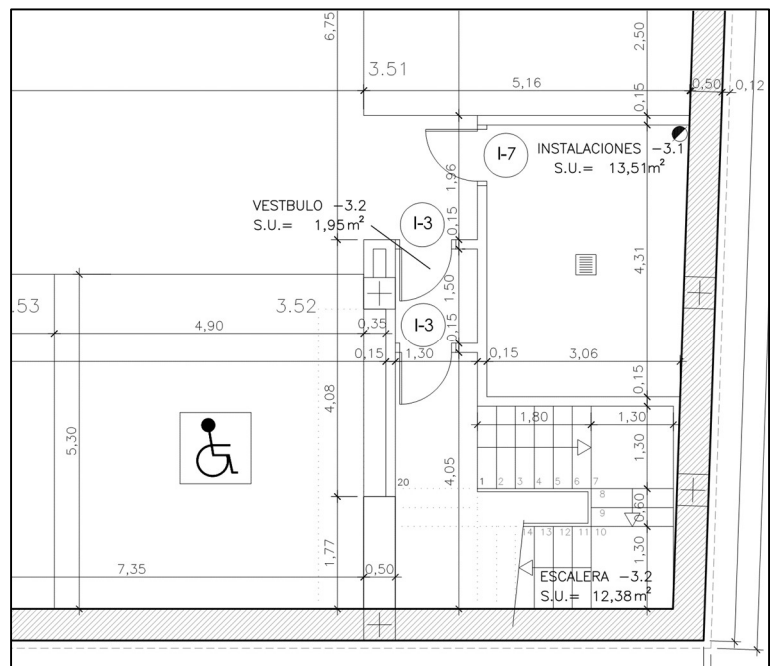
Detalle del plano de replanteo del SOTANO -3.
